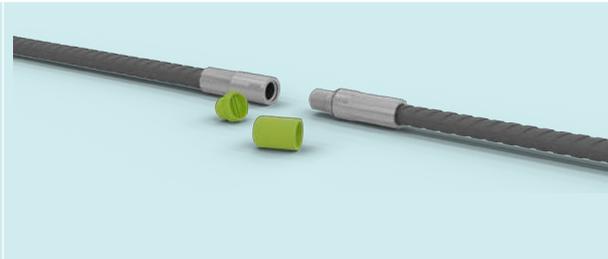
Träger mit Schweißdeckeln zum Verschließen der Stegöffnungen und MODIX® Muffenteil A
